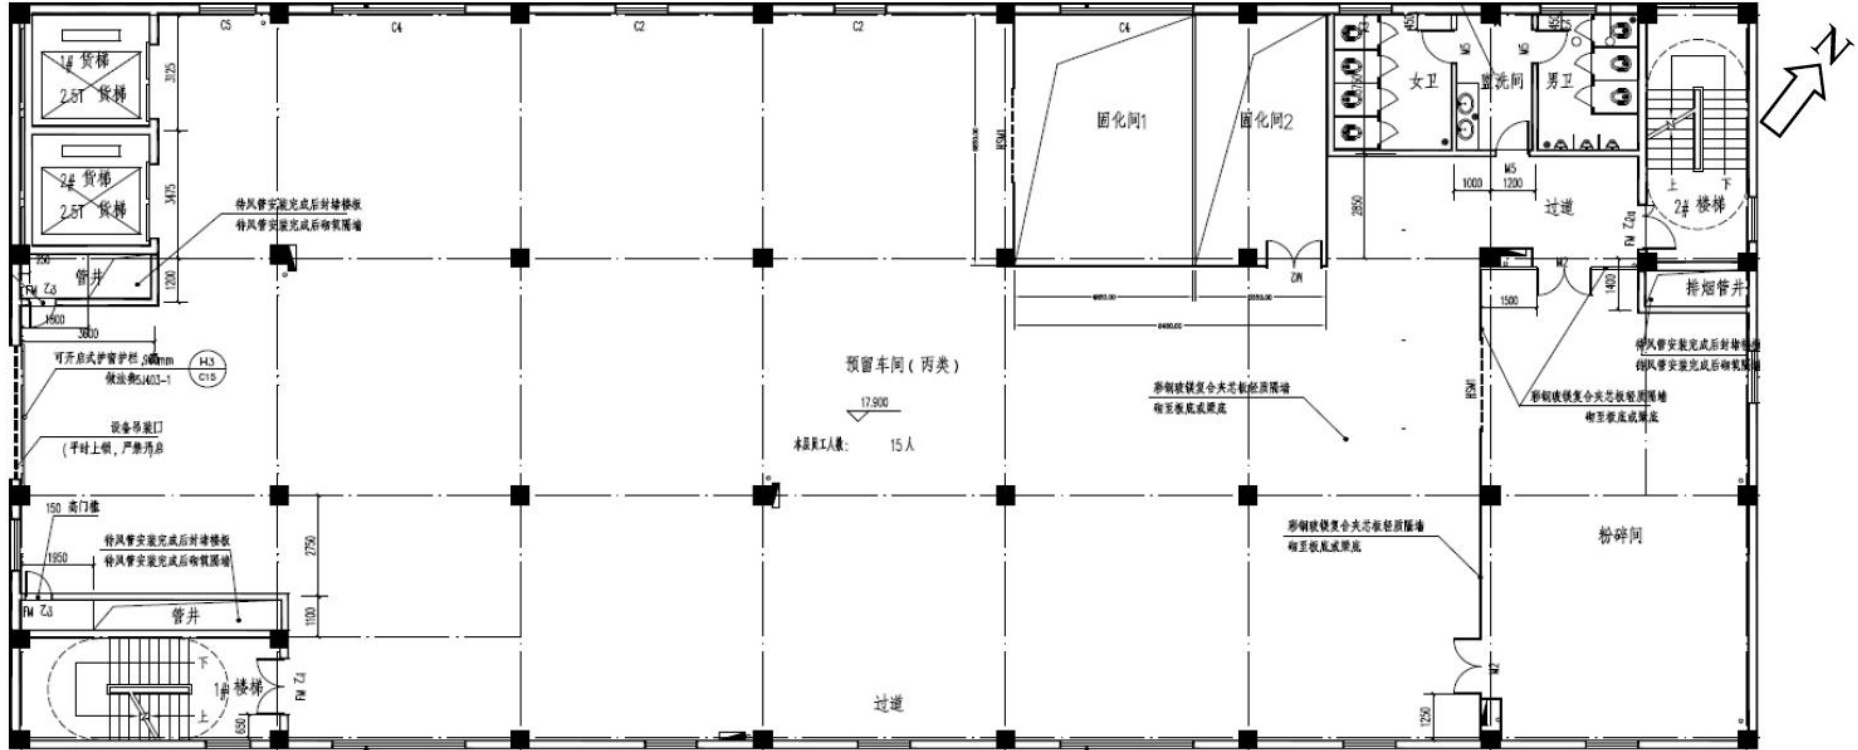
扩建项目平面布置图 (丙类车间四层)
